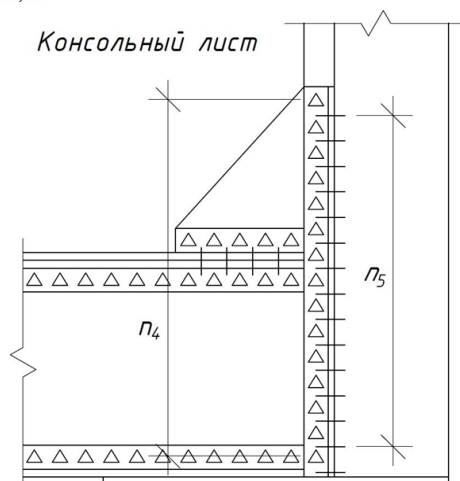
Крепление поперечной балки к главной ферме (балке)
